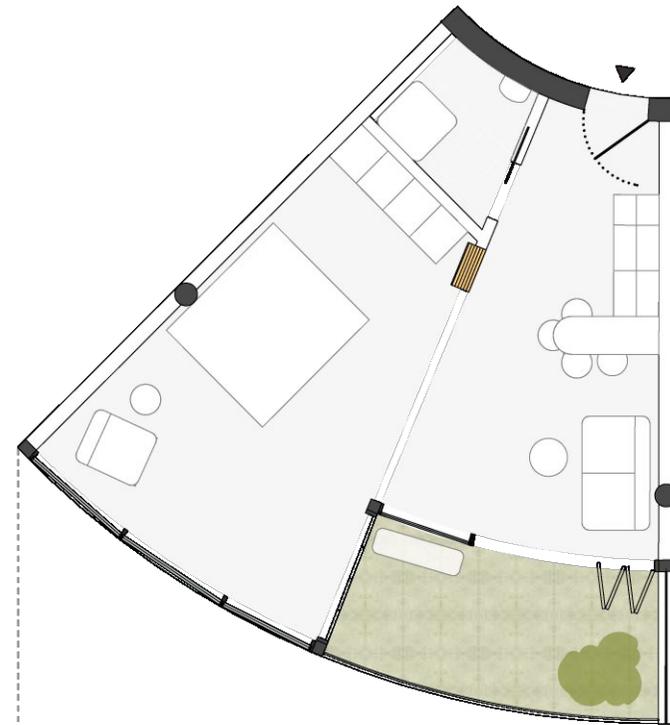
Grundriss Wohnung Typ A.c, offen
